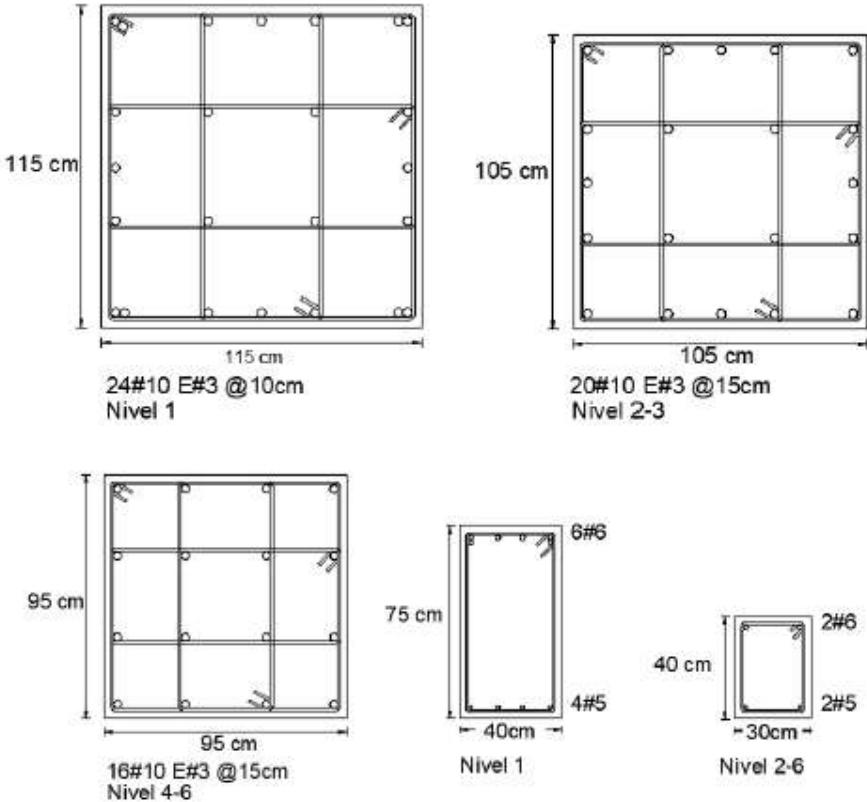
Secciones finales de columnas y vigas del edificio de 6 niveles diseñado con las NTCS-2017 y  $Q=4$  [imágenes tomadas de Gregorio, 2020]
